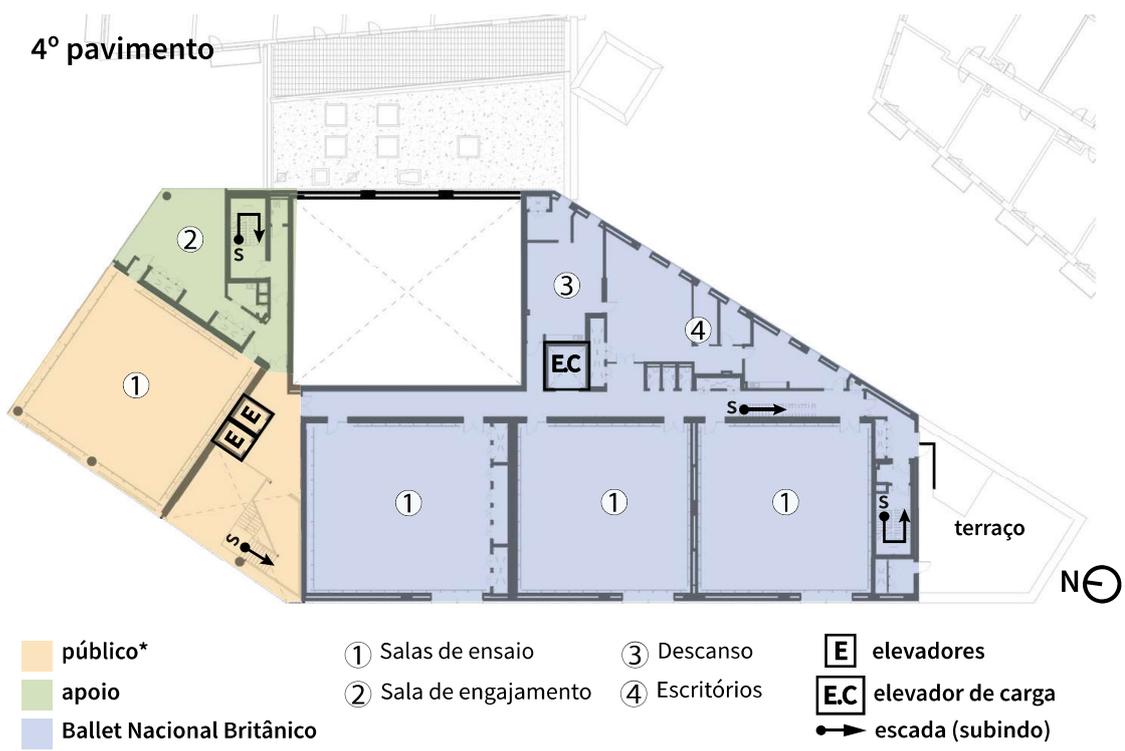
planta do 4º pavimento. Fonte: ArchDaily com intervenções da autora
